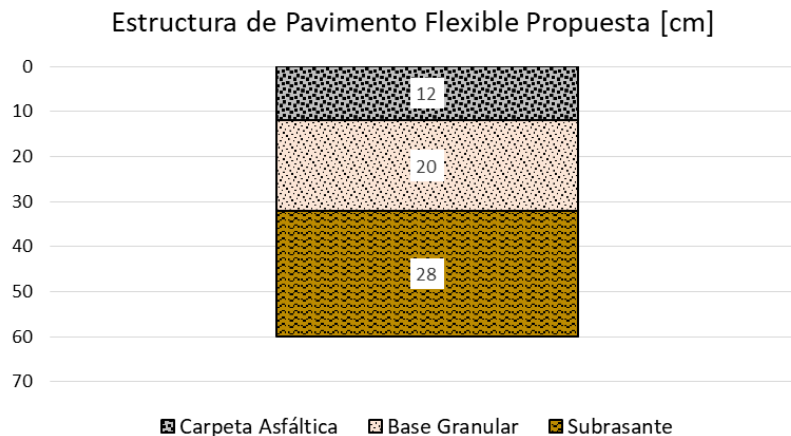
Estructura de Pavimento Flexible Propuesta
